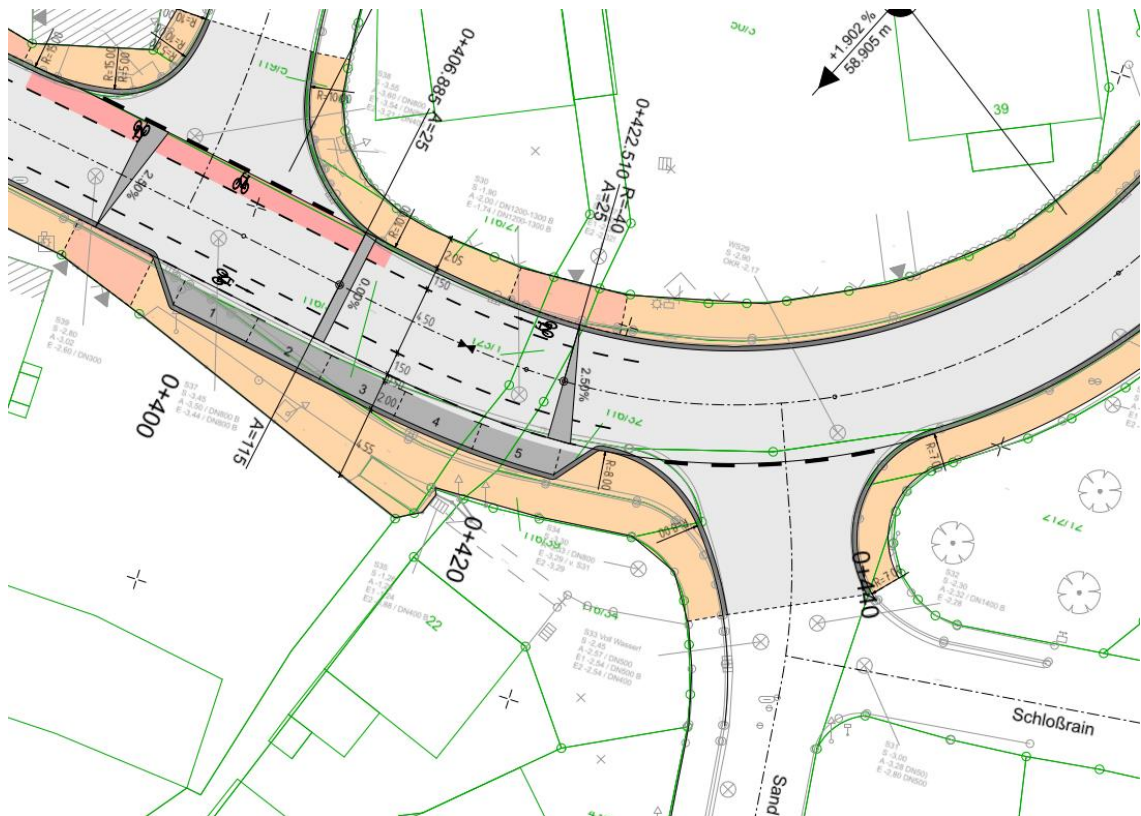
Planausschnitt Variante 1 - Radfahrerführung
